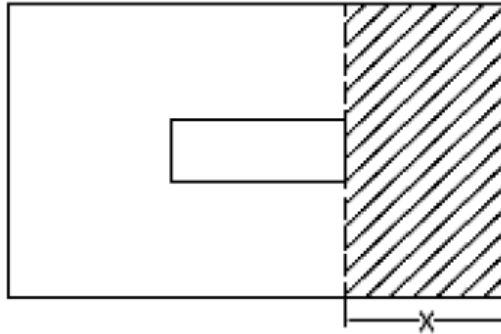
Sección considerada para el cálculo del refuerzo por flexión.
